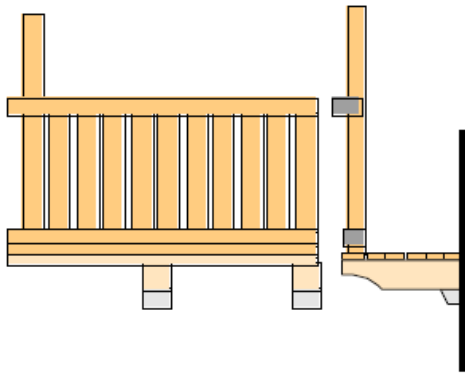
Schema di "linda" caratterizzante la facciata interna dell'edificio principale della corte
